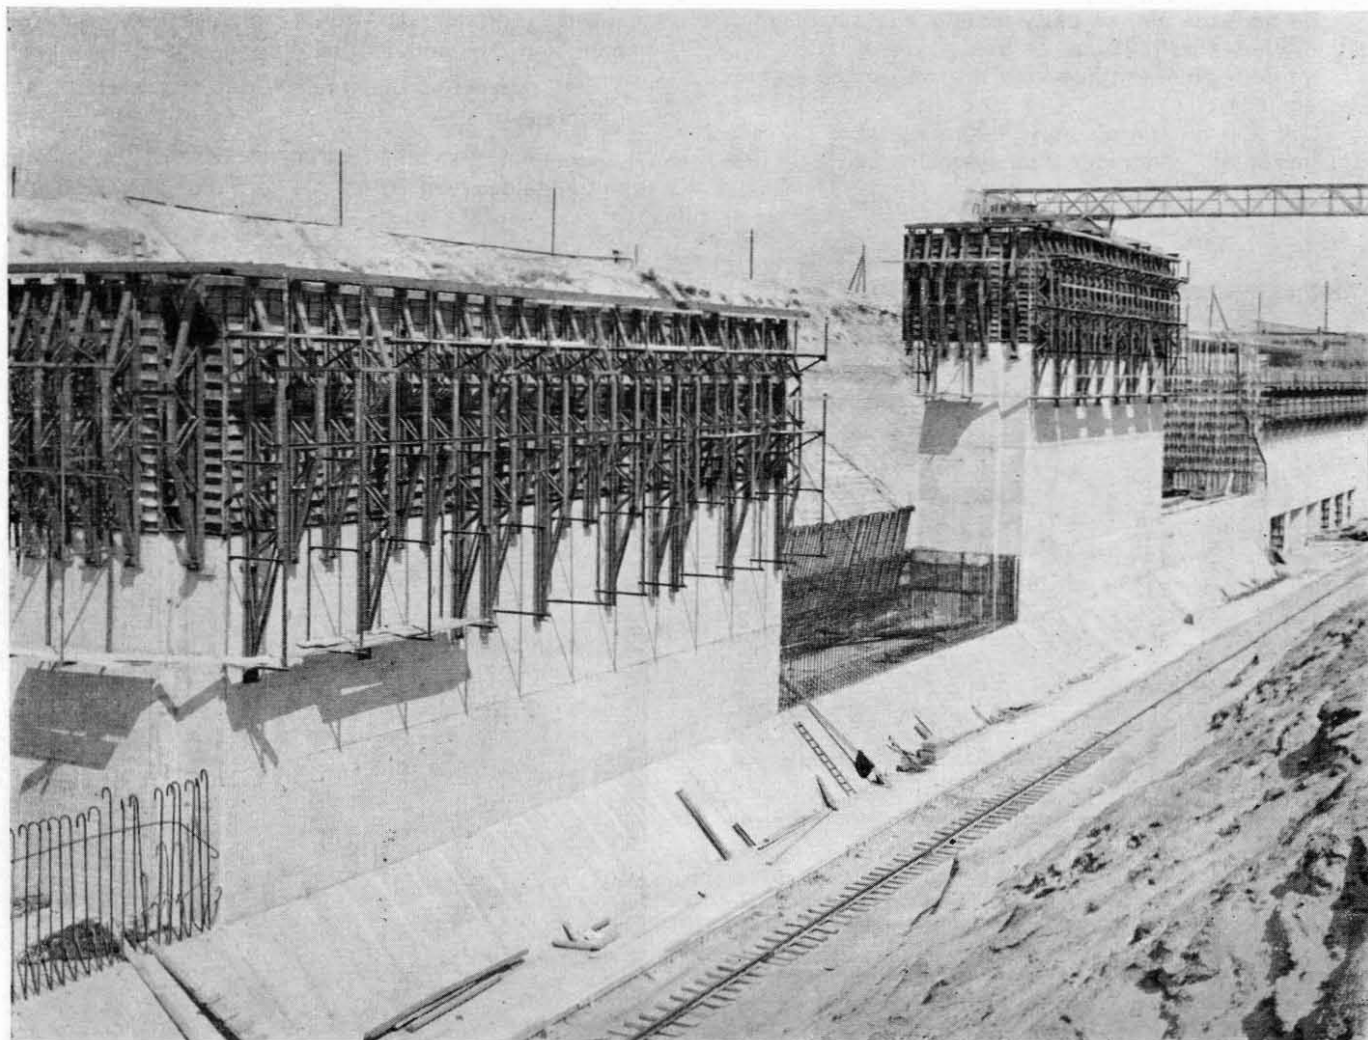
Les coffrages KWIKFORM sont utilisés pour bétonner les murs de bajoyer, par sections de 4 m. d'élévation en une fois.
